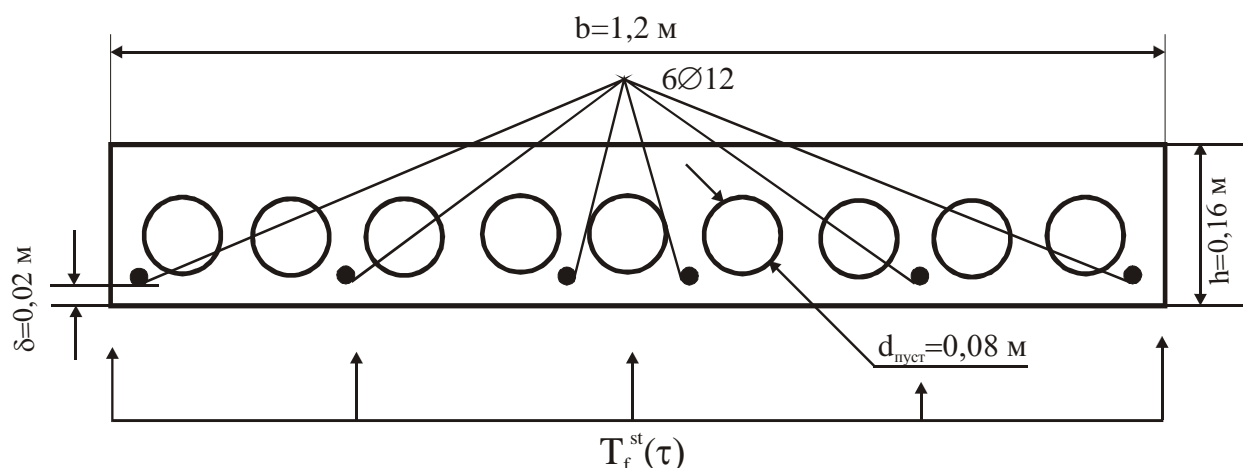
Поперечное сечение заданной многопустотной железобетонной плиты перекрытия и принятая схема воздействия пожара на плиту
